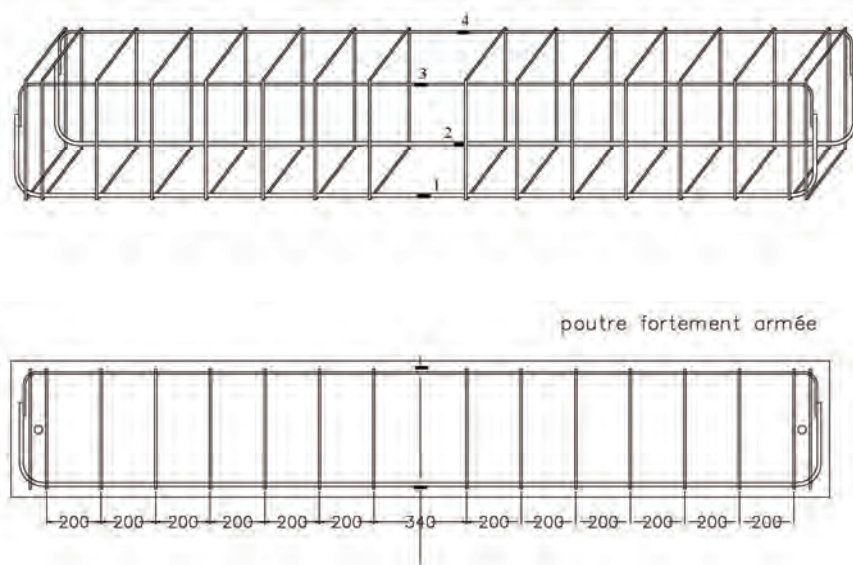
7 : plan d'instrumentation du ferrillage FA
